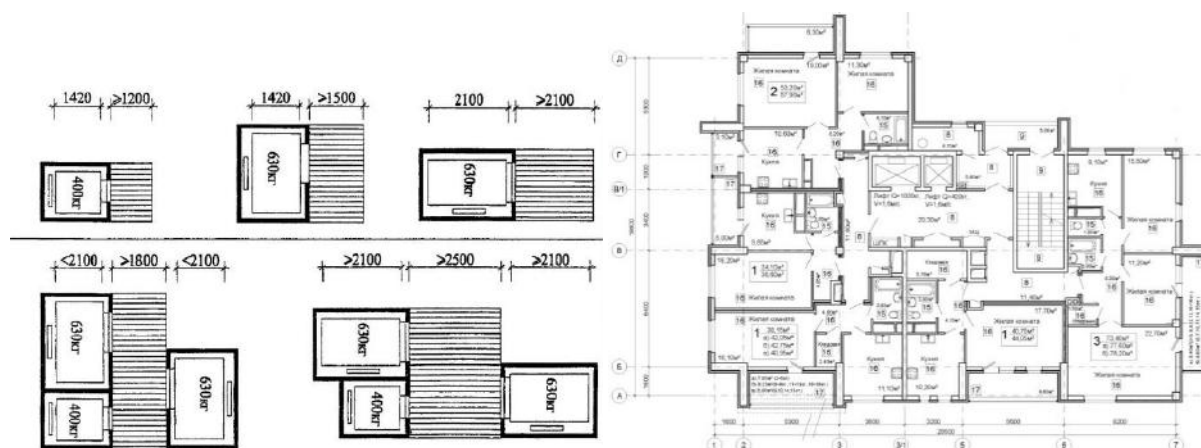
Размеры площадок перед лифтами, план типового этажа
